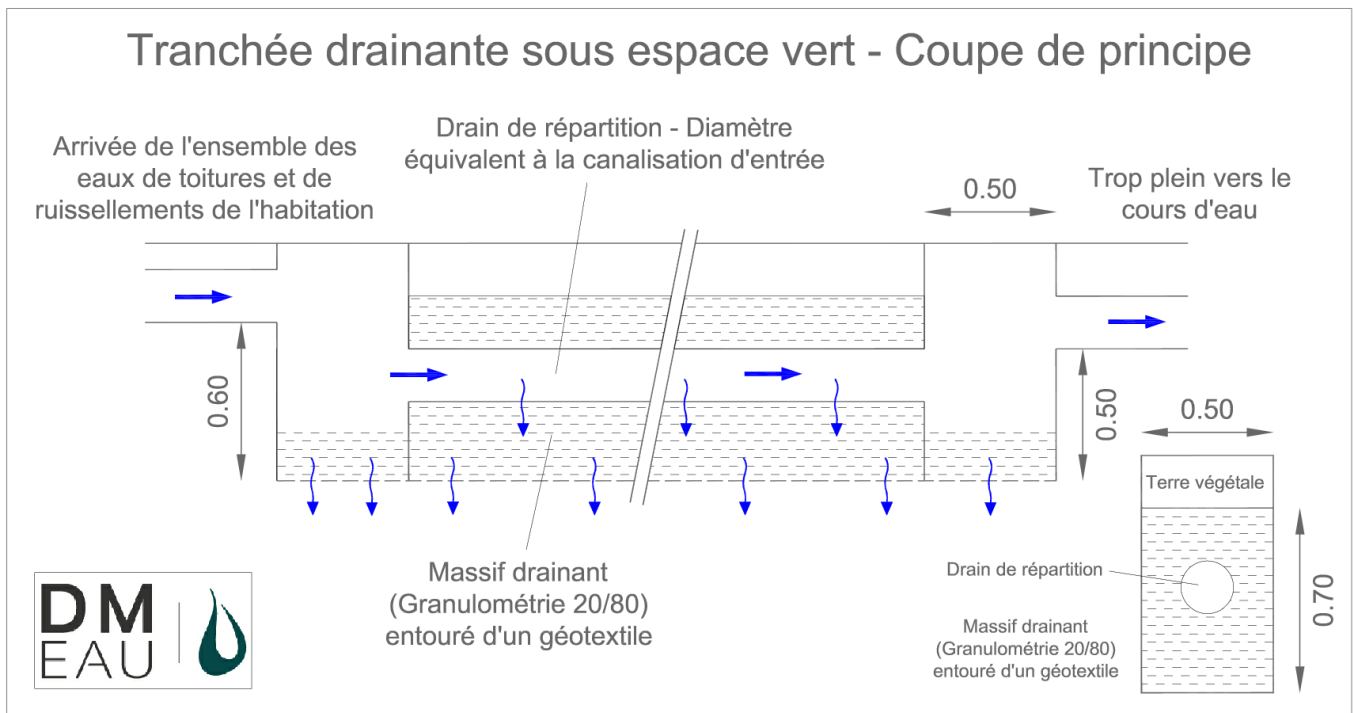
Schémas de principe : coupe d'une tranchée drainante sous espace vert
